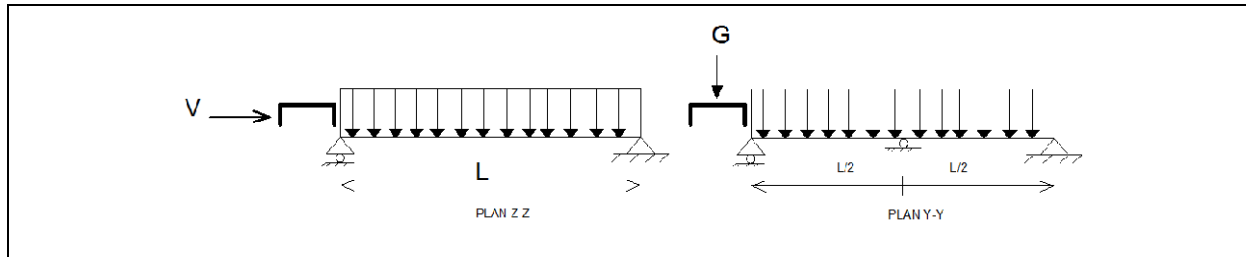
les schémas statiques de la lisse dans les deux plans y-y et z-z.
